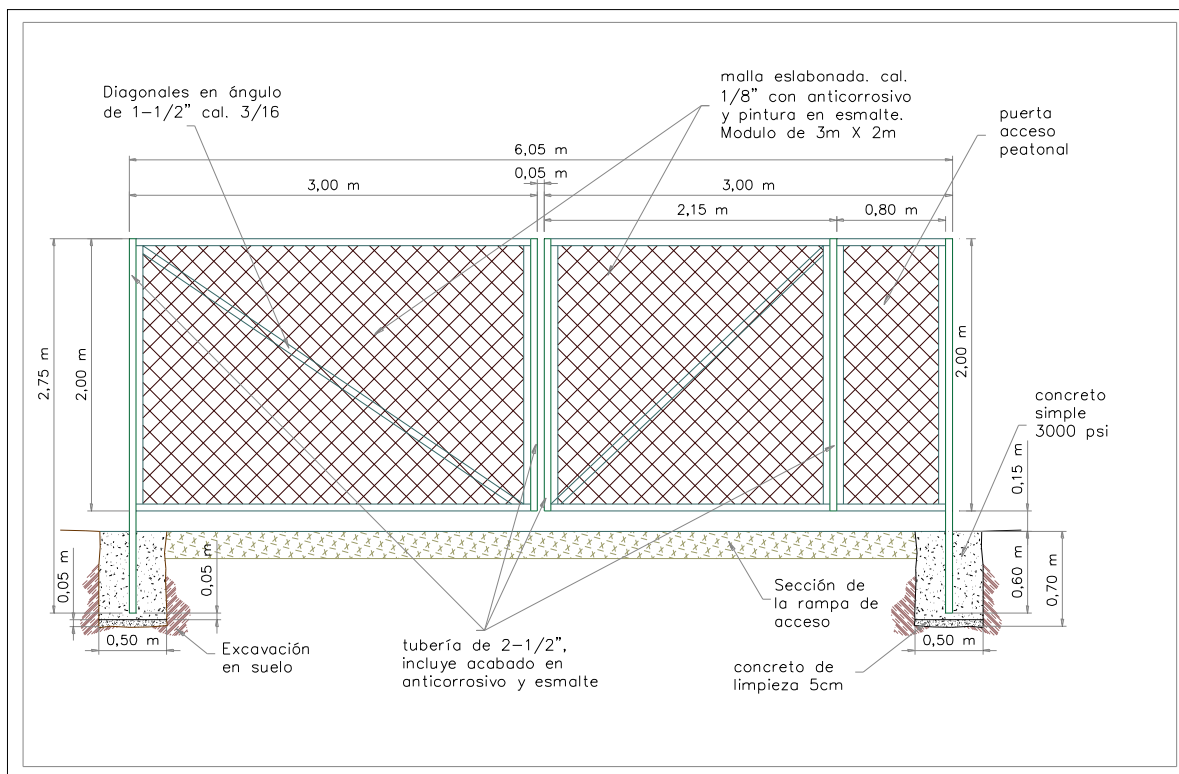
Propuesta de Cerco Perimetral en alambre
